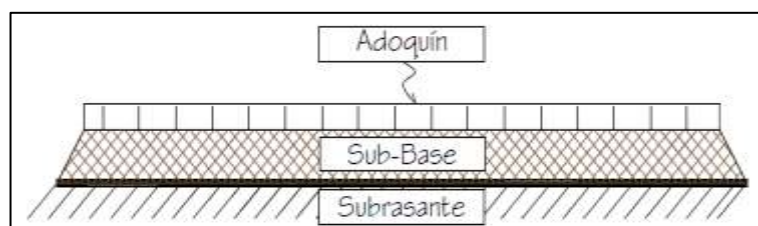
Sección típica transversal de un pavimento semi-rígido.
